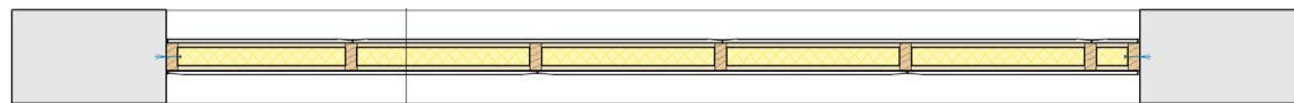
bovenaanzicht van meting nr. 8 met wandconstructie HSB 114/1.89.1.A
